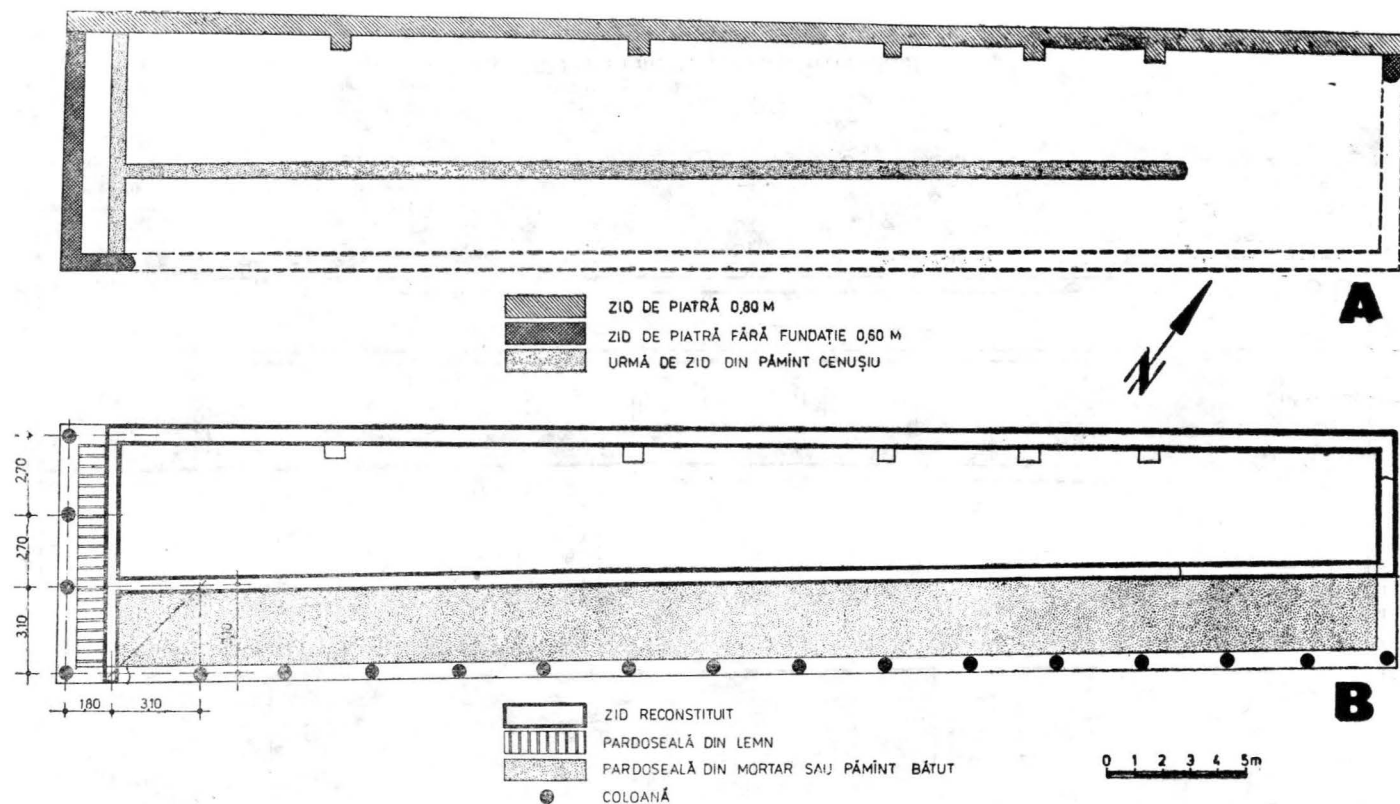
Baraca nr. 4: a. planul descoperirii; b. plan reconstituit
